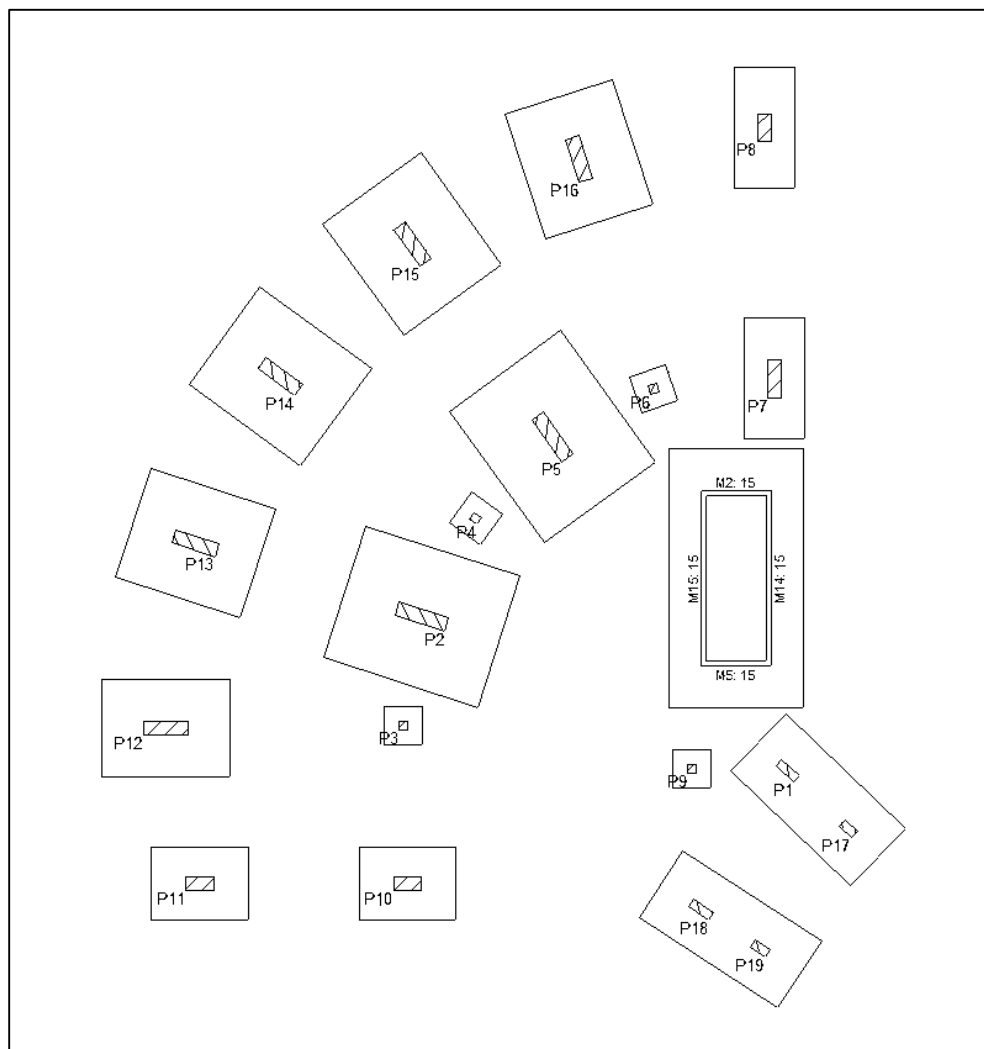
Vista en planta- Ubicación de la Cimentación del Edificio Alcaldía de Villavicencio
